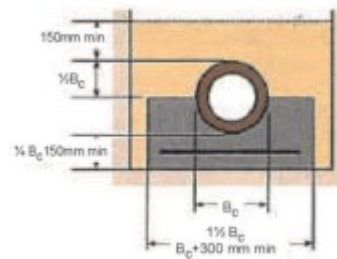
Zonë rrethuese me beton të përforcuar
